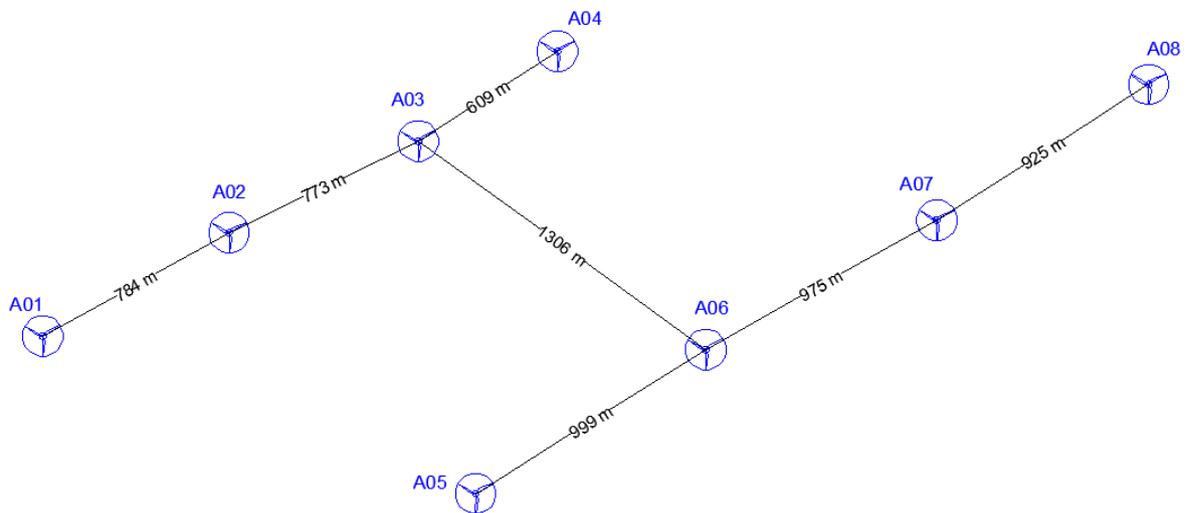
Schema layout con indicazione delle interdistanze tra le tribune di progetto
